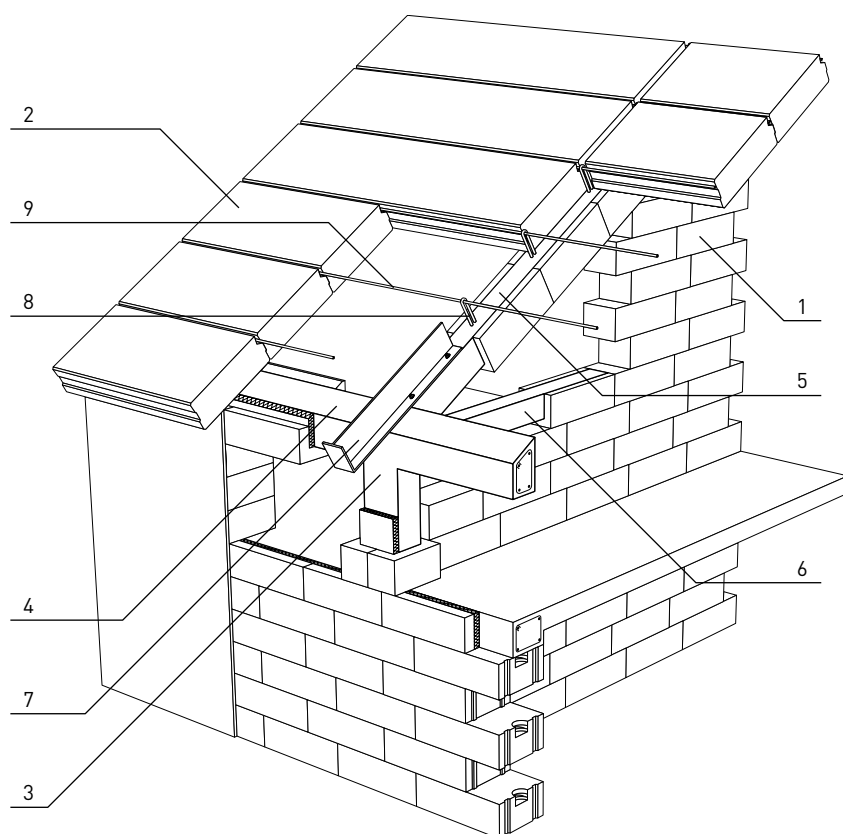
Stropodach budynku halowego o konstrukcji stalowej z obudową z płyt dachowych i bloczków ściennych YTONG.
